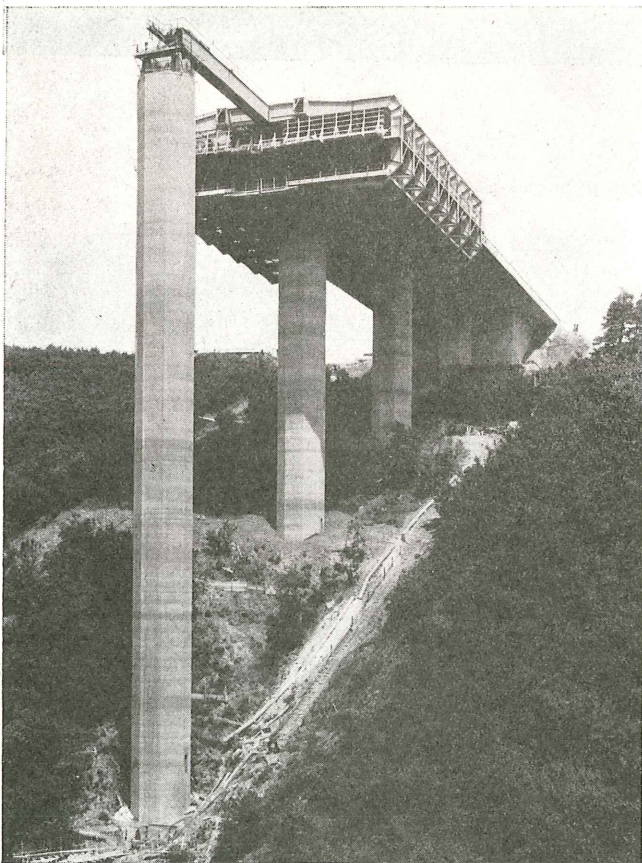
Construcción del puente del Elzta. Detalle de la cimbra móvil autoportante.
